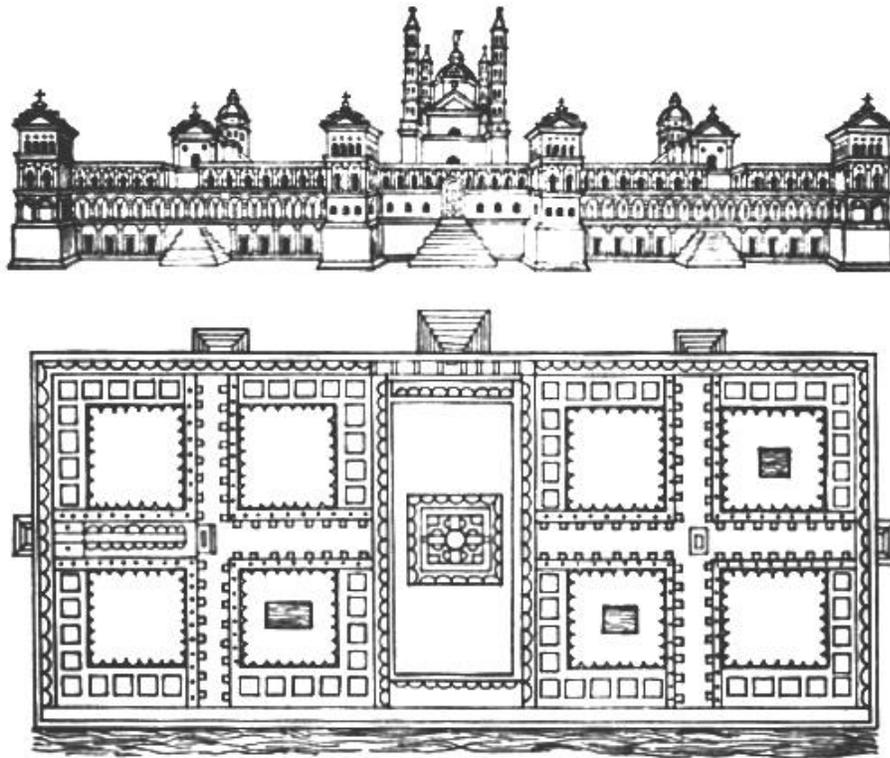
Fachada e planta do *Ospedale Maggiore* (Milão, Itália), projetado em 1456. por *il Filarete* (1400-69). (Fonte: CLASS CONECTION, 2010; adaptado)
